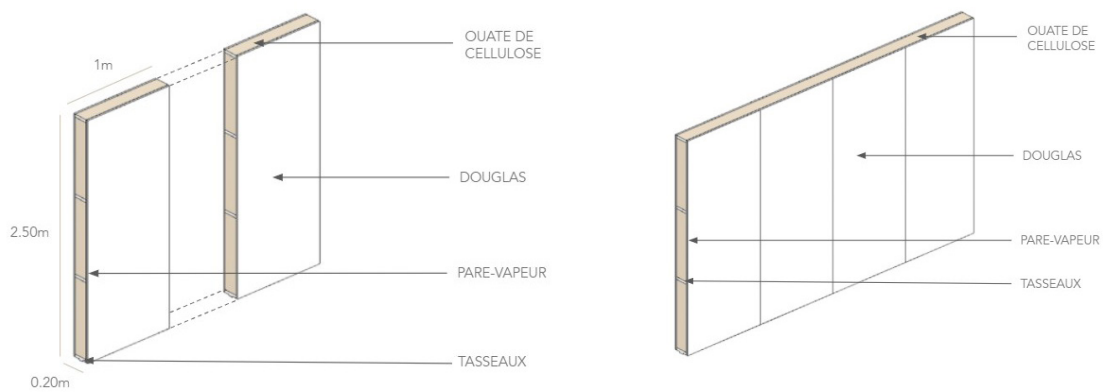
Principe constructif d'une cloison en bois : emboîtement positif/ négatif
